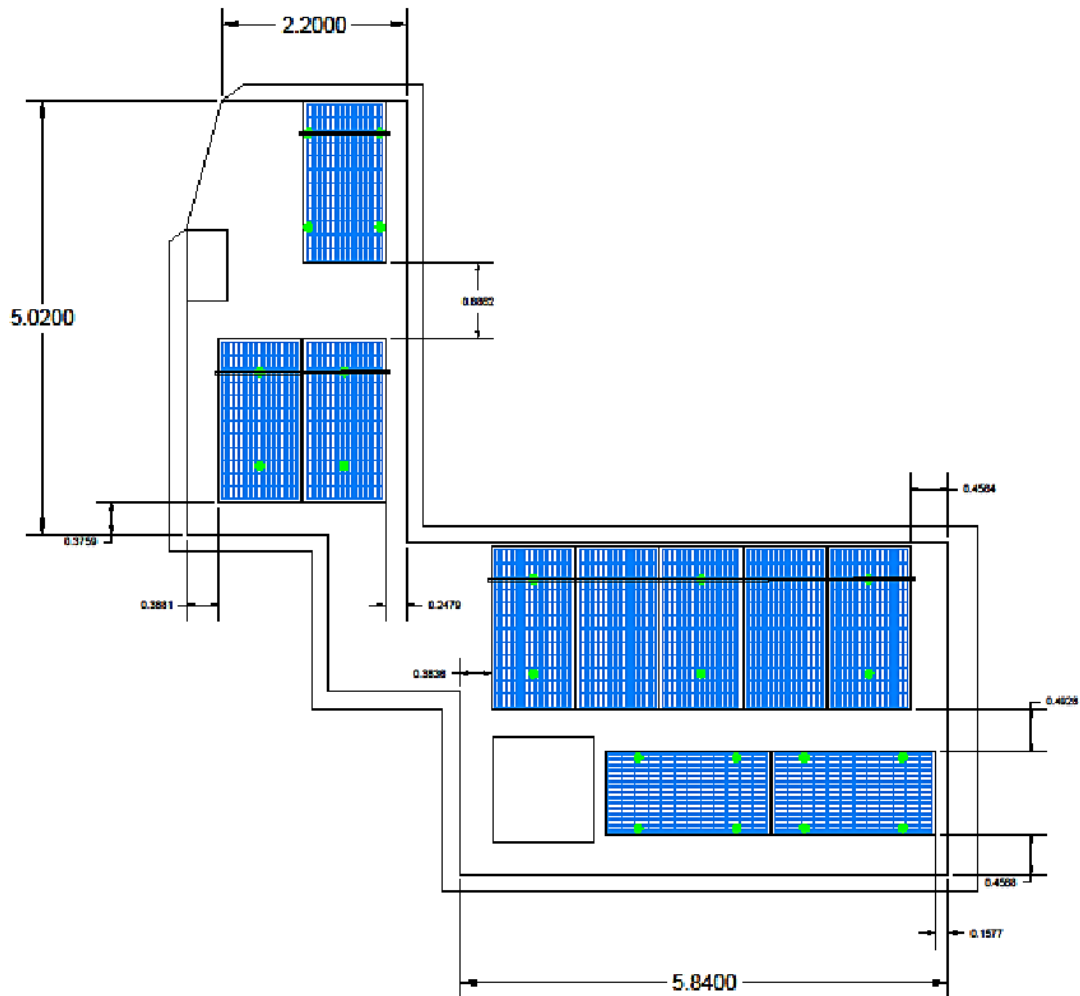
Plano de ubicación de módulos, vista de planta: aporte propio.
